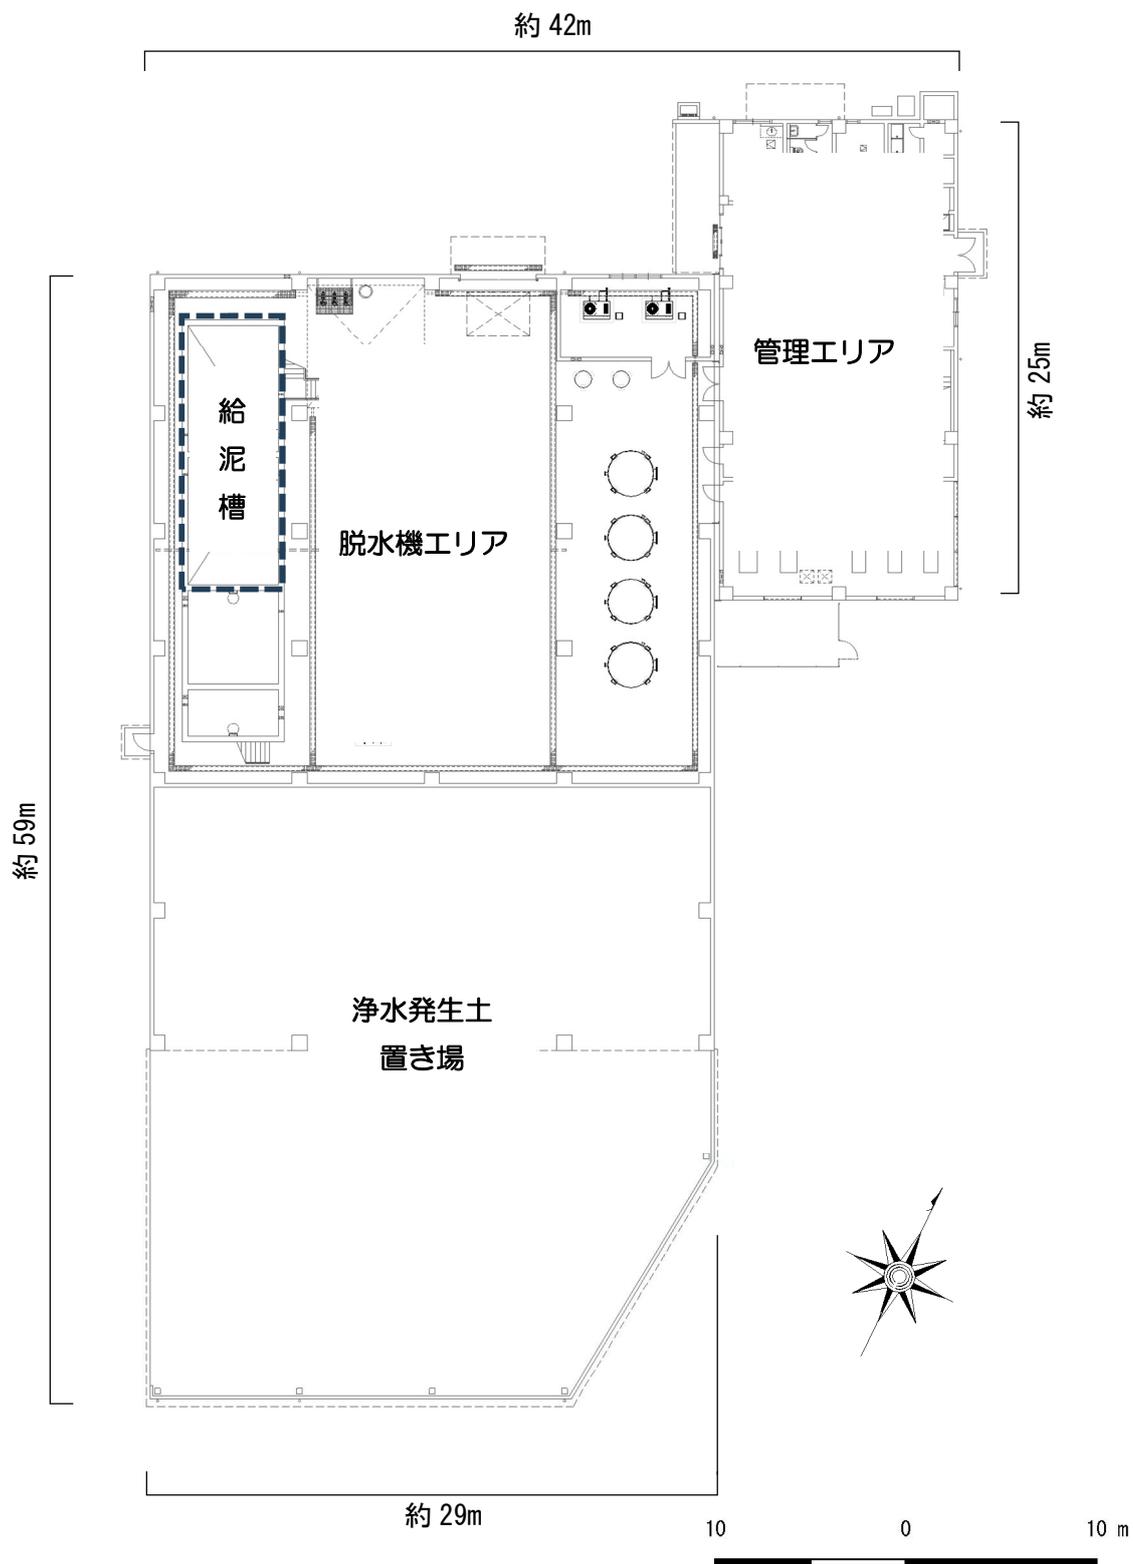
(1) 1階平面図 (縮尺 1:400)
